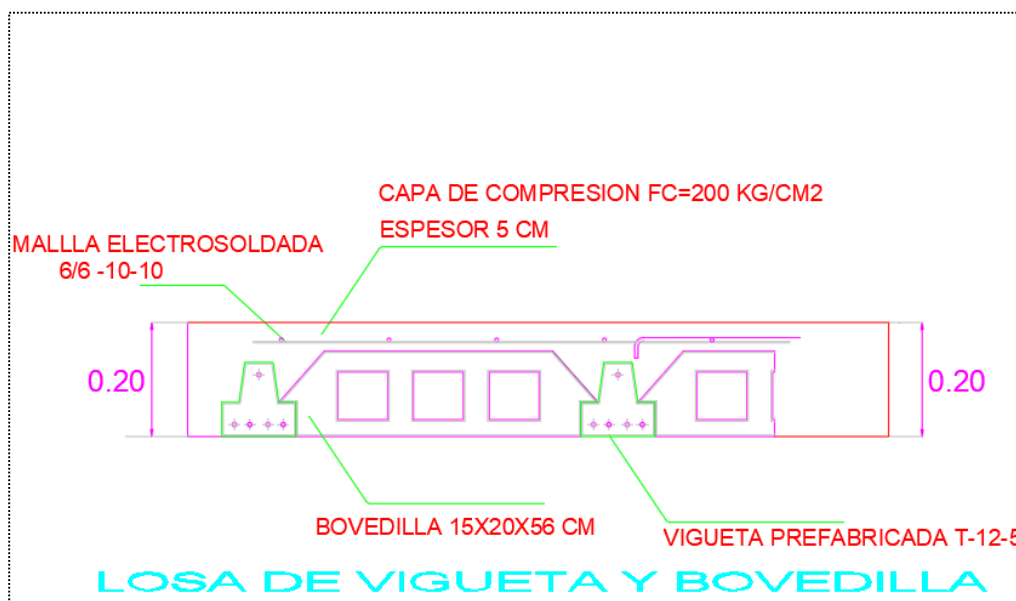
Detalles estructurales (sección de plano arquitectónico).
